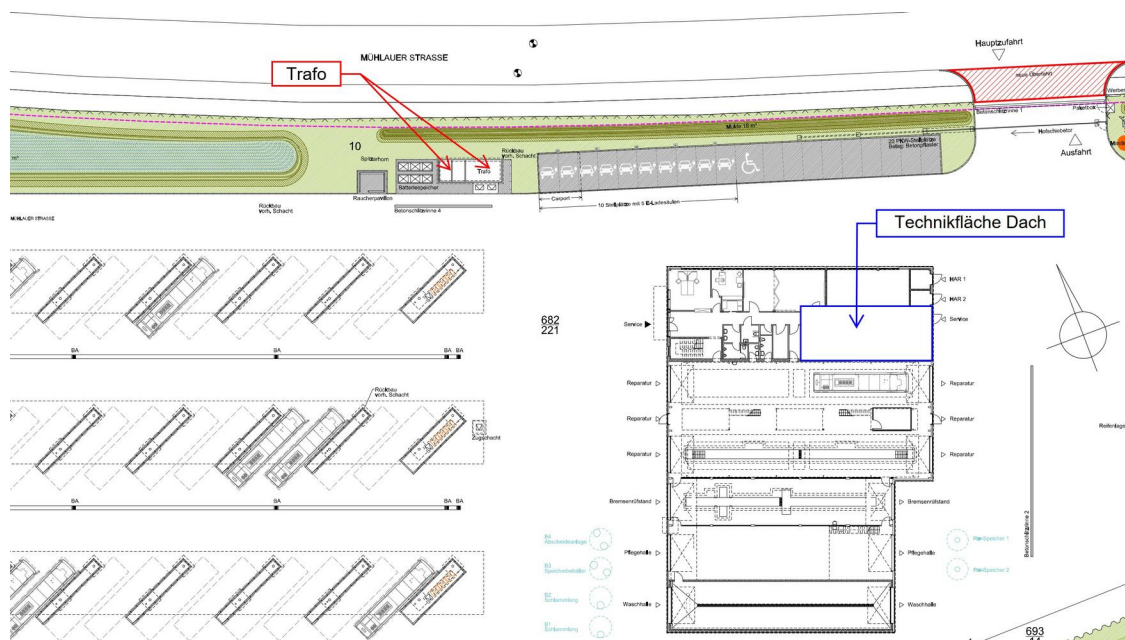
Lage der geplanten Technischen Gebäudeausstattung
